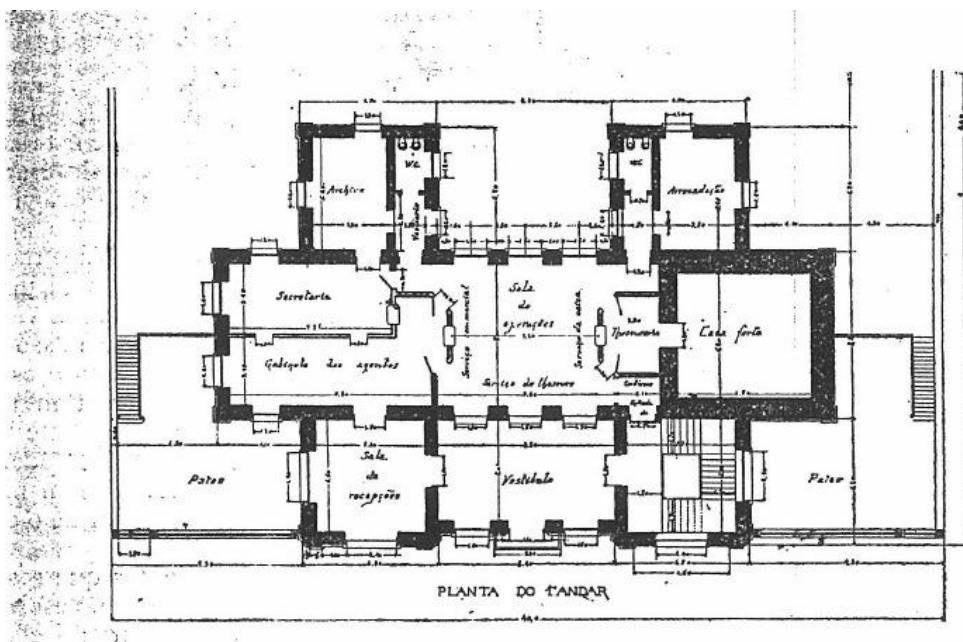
Desenho da planta do 1º andar do mesmo edificio.
